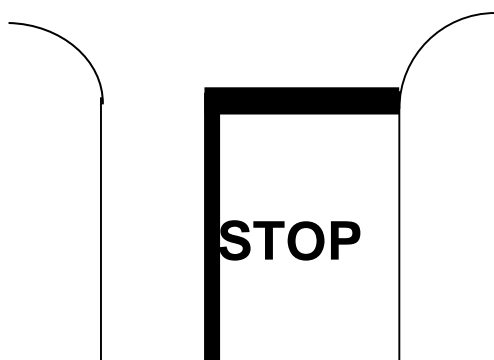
Schéma de signalisation stop sur chaussée.
